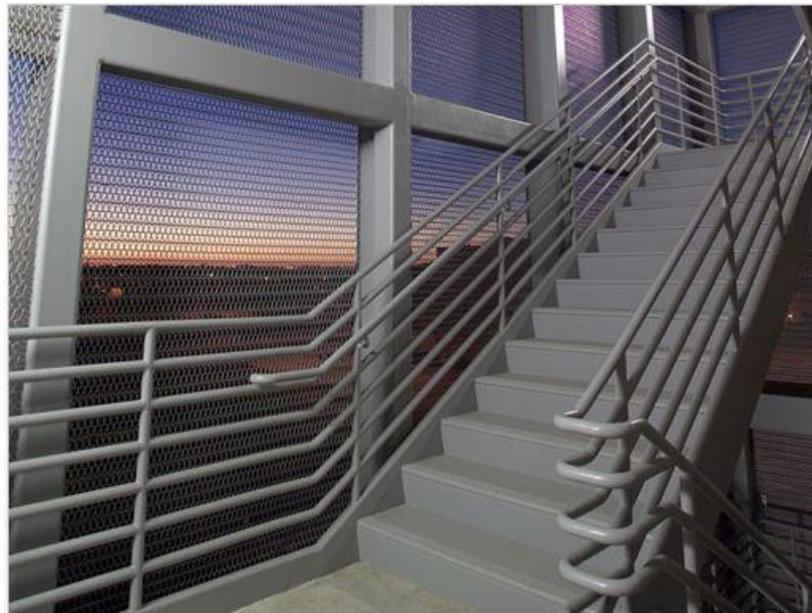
Estructuras abiertas – Sistema de ventilación con mallas de tejido metálico
